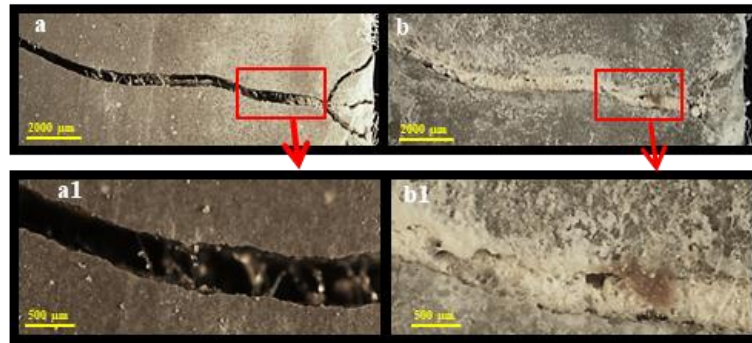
Imagem das fissuras: a- após pré-fissuração; b- 14 dias
